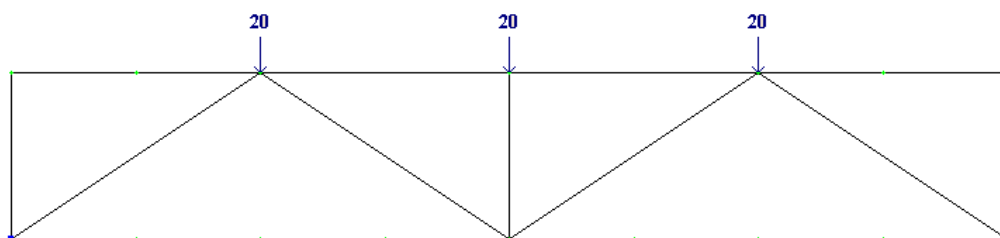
Розрахункова схема ферми з паралельними поясами
